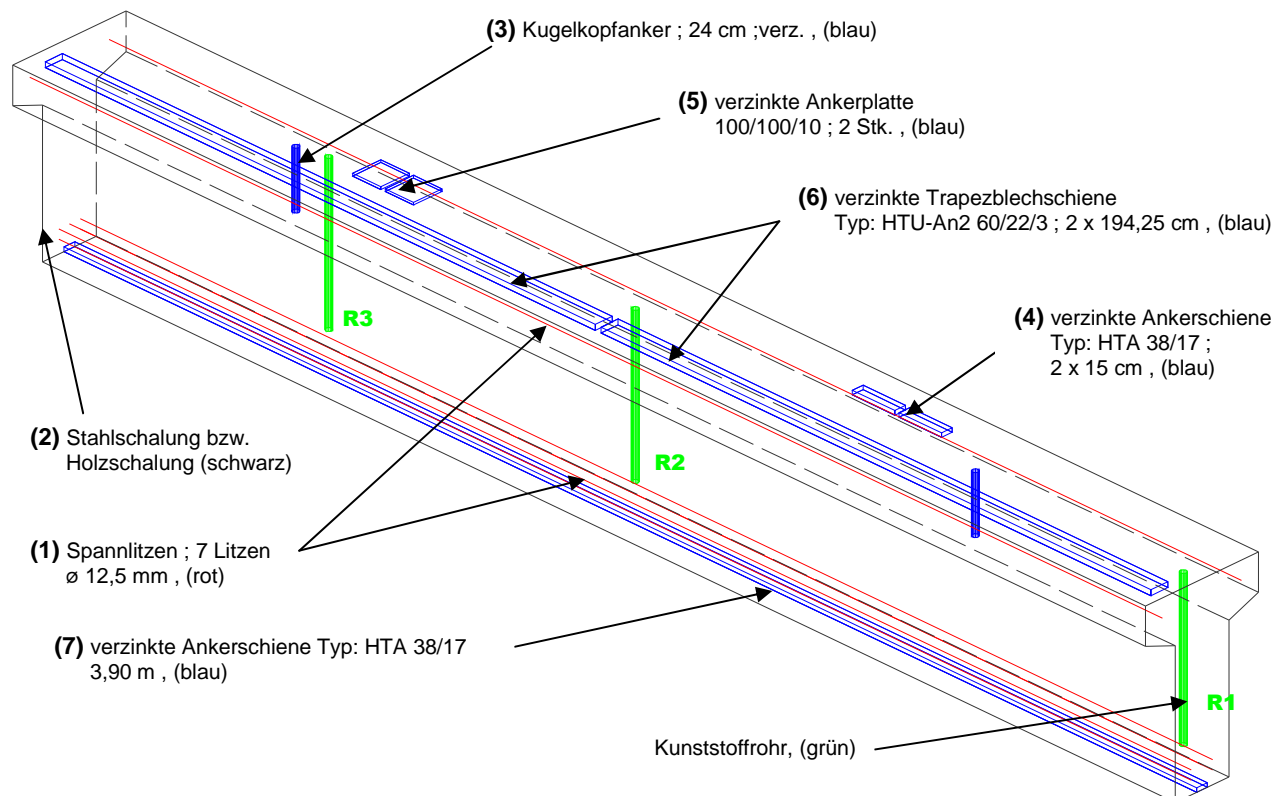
Skizze Spannbetonbinder aus Stahlfaserbeton Fa. Rekers
